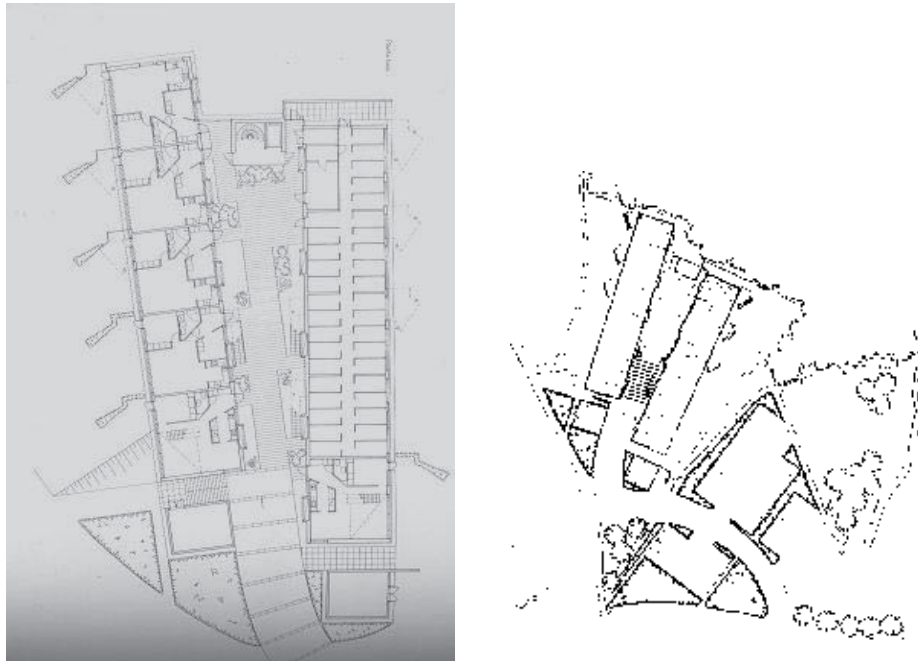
Planta arquitectónica (izquierda) y palta de conjunto (derecha).
